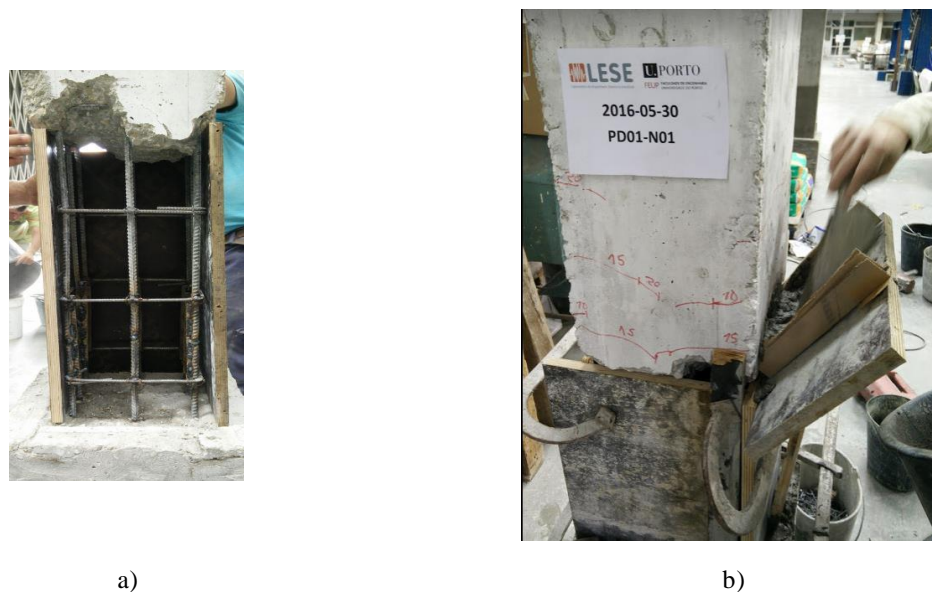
a) Colocação da cofragem; b) Betonagem do pilar
